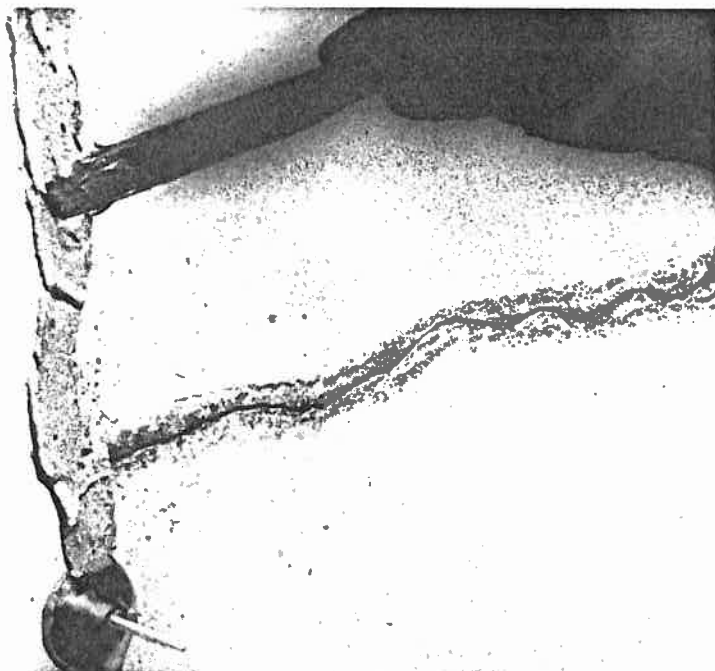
Aplicação de um ligante epóxico a selar os bordos da fissura
